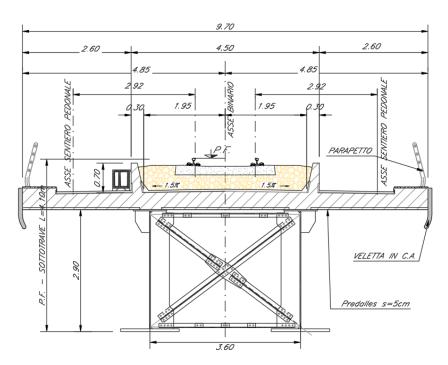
sezione trasversale impalcato tipo in acciaio 40m singolo binario
